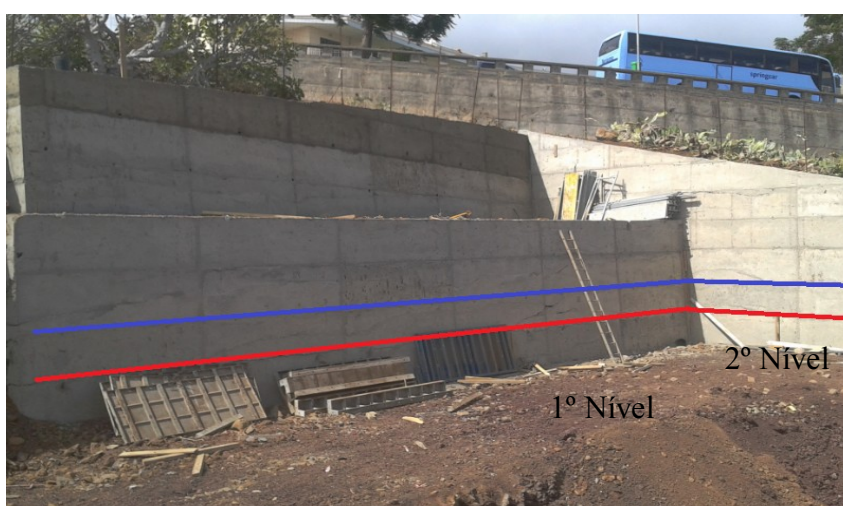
Faseamento de construção dos muros em betão ciclópico
